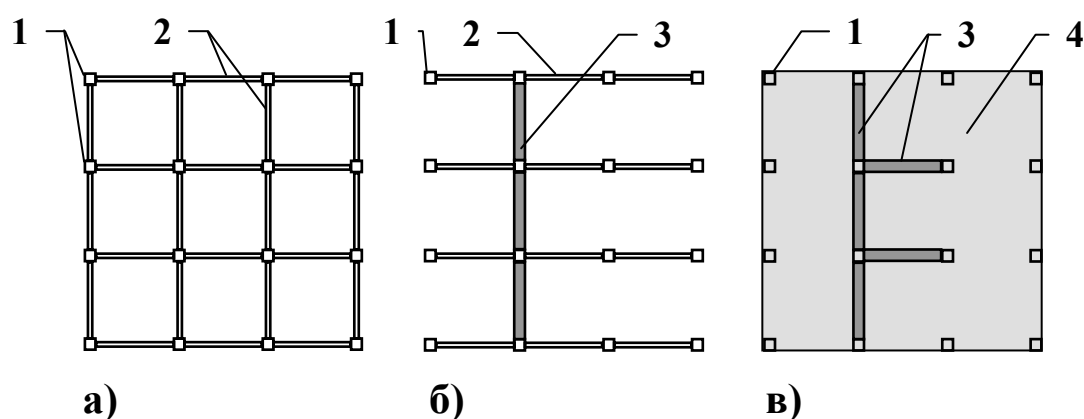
Схеми каркаса в будівлях підвищеної поверховості:
